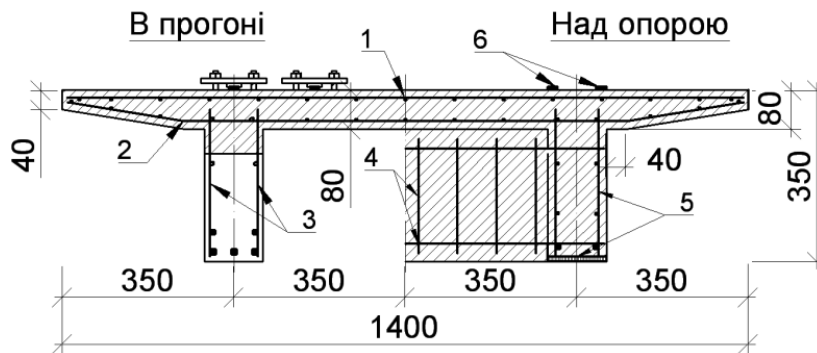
Розміщення арматурних виробів у поперечному перерізі дослідної конструкції: 1-верхня сітка плити С-1, 2-нижня сітка плити С-2, 3- арматурний каркас збірної залізобетонної балки, 4- каркас поперечної балки, 5- закладна деталь надопорної балки, 6-високоміцна неметалева стрічкова армура Sika Carbodur туну S.
